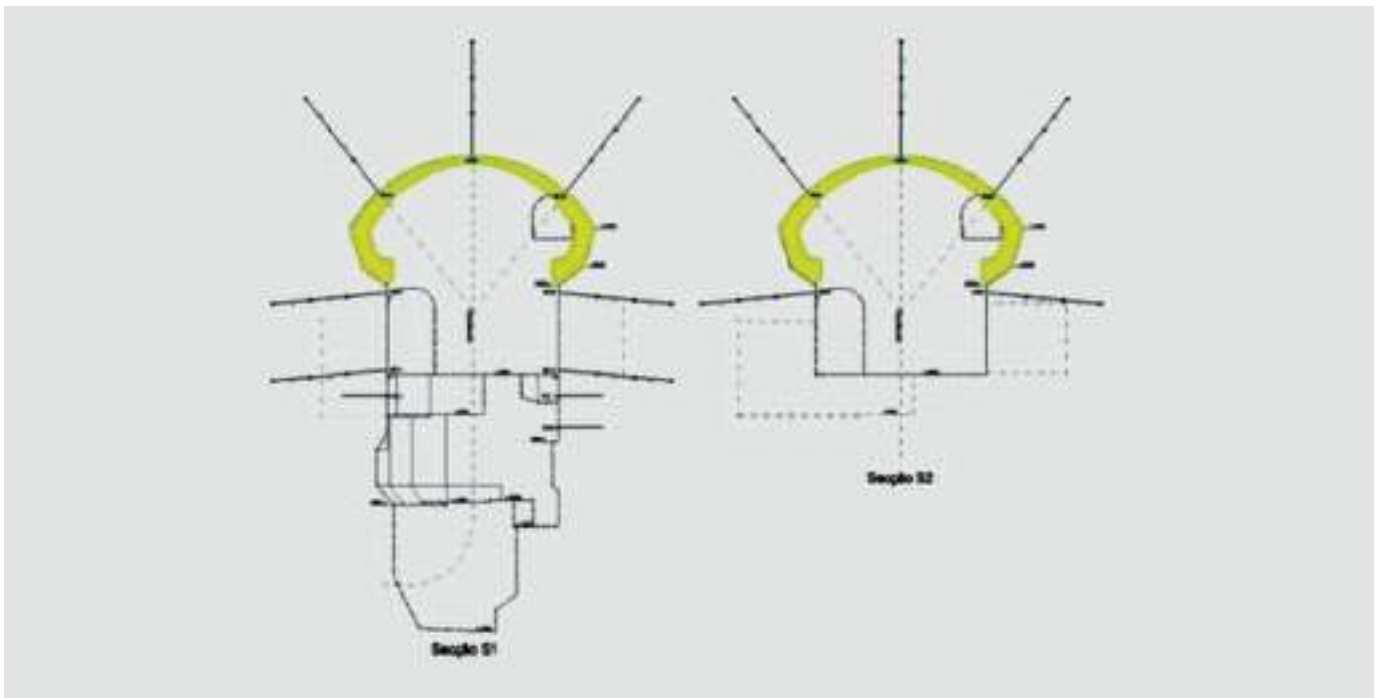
Escavação do núcleo da caverna, após betonagem da abóbada.
